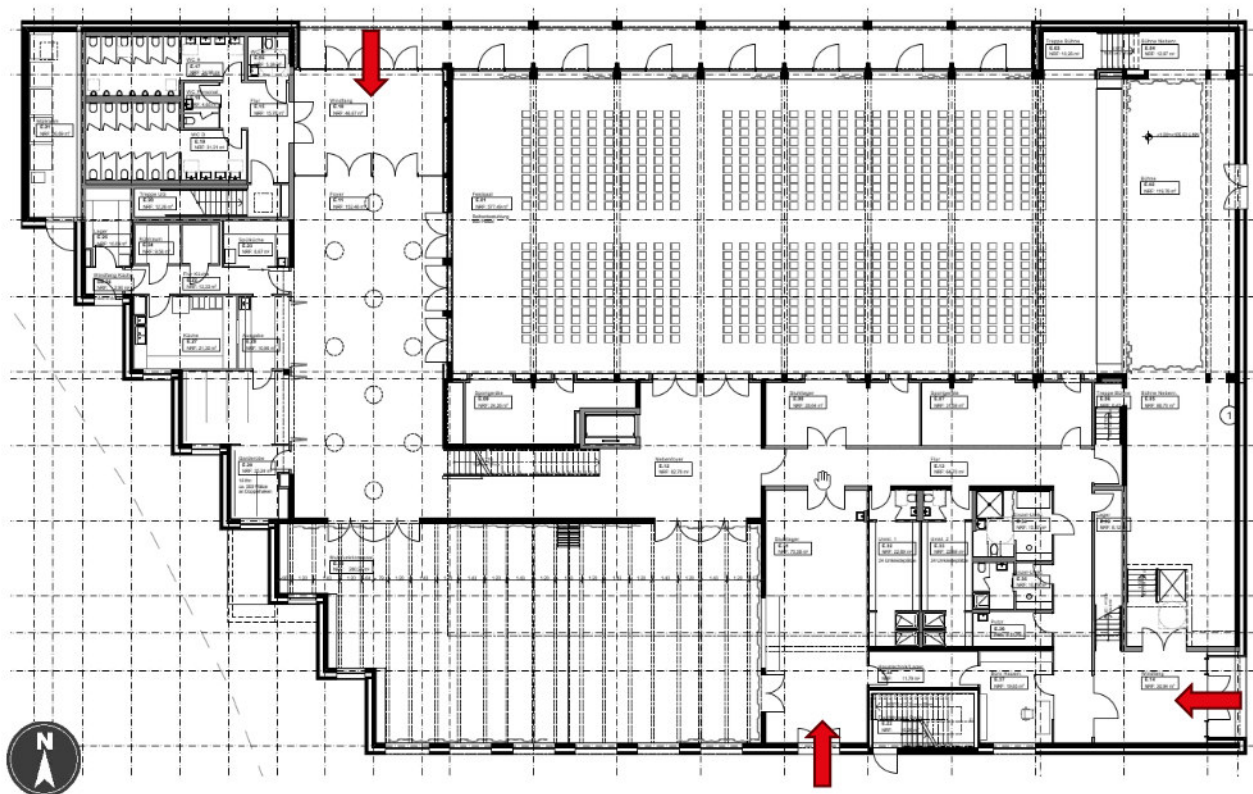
| Ausschnitt Erdgeschoss [Quelle: Drei Architekten]
